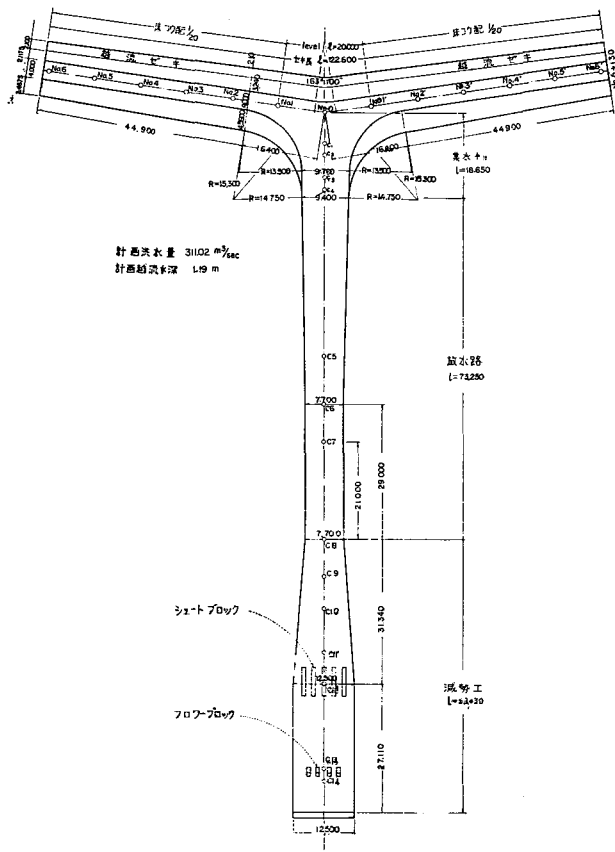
千葉県小糸川地区三島ダム余水吐平面図
